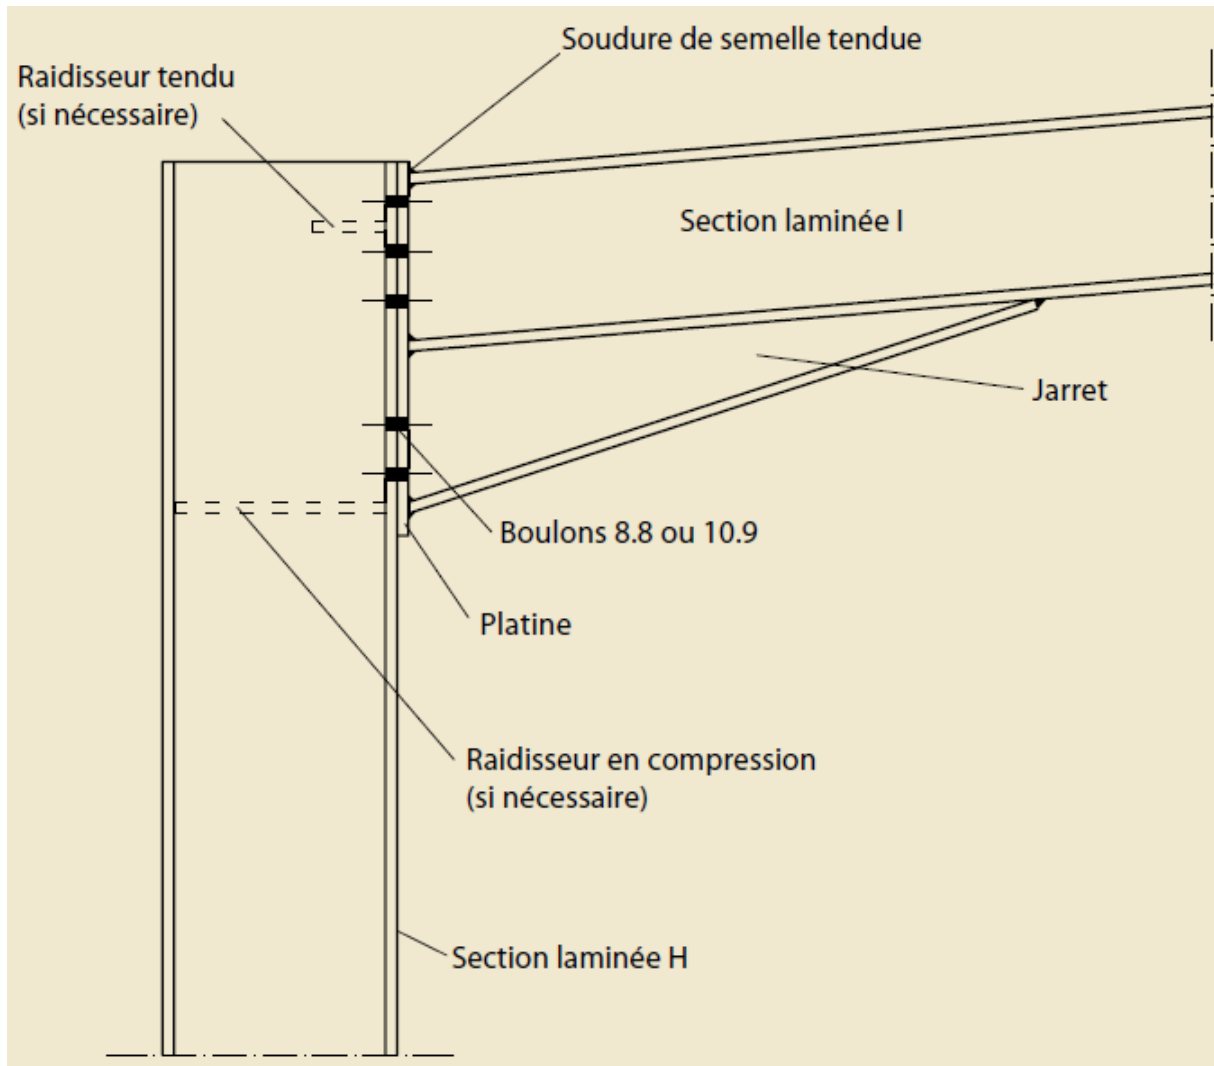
Assemblages poteaux-poutres typiques dans un portique
